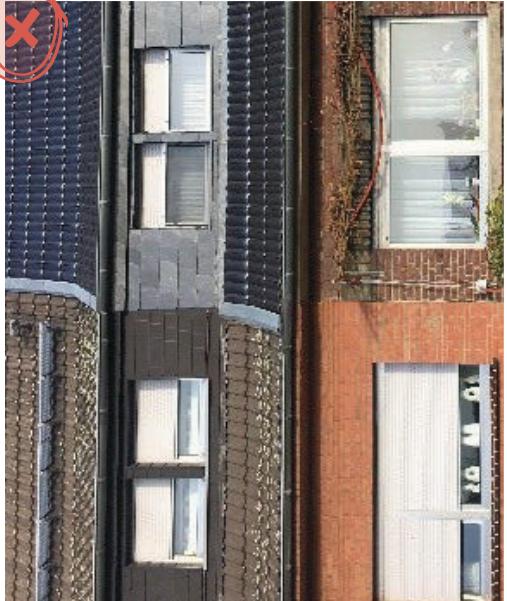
unterschiedliche Dachdeckungen bei benachbarten Gebäuden wirken unruhig
